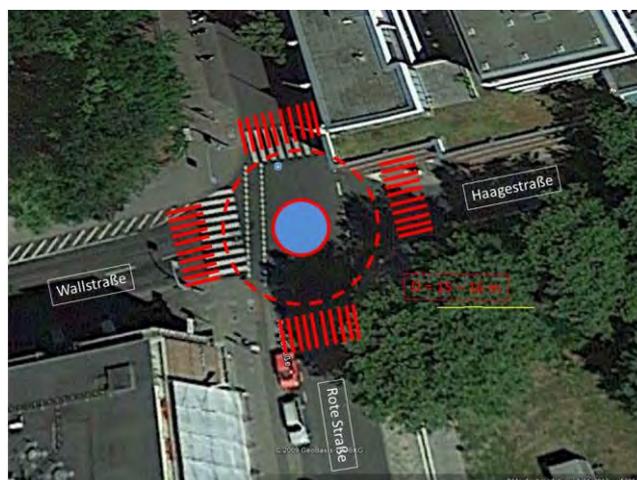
Prinzipskizze Minikreisverkehr Rote Str. / Wallstraße / Haagestraße
